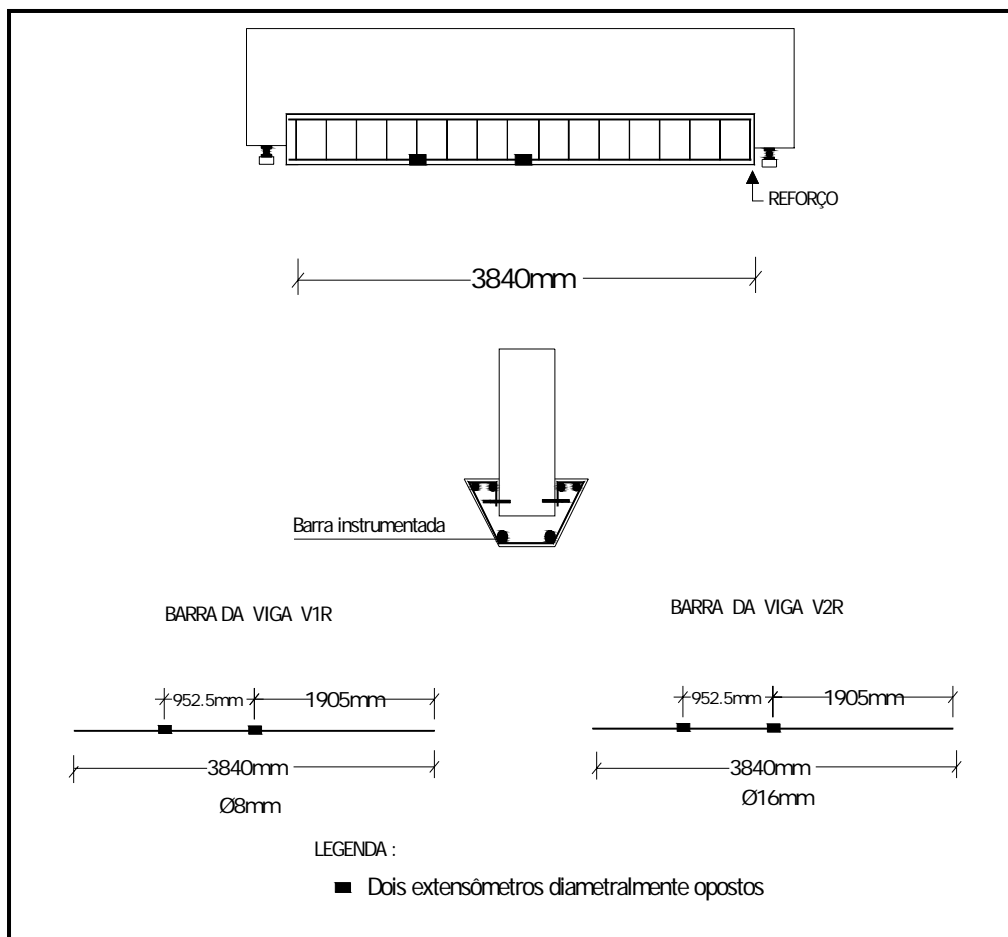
Posição dos extensômetros para medição da deformação na armadura longitudinal do reforço.
